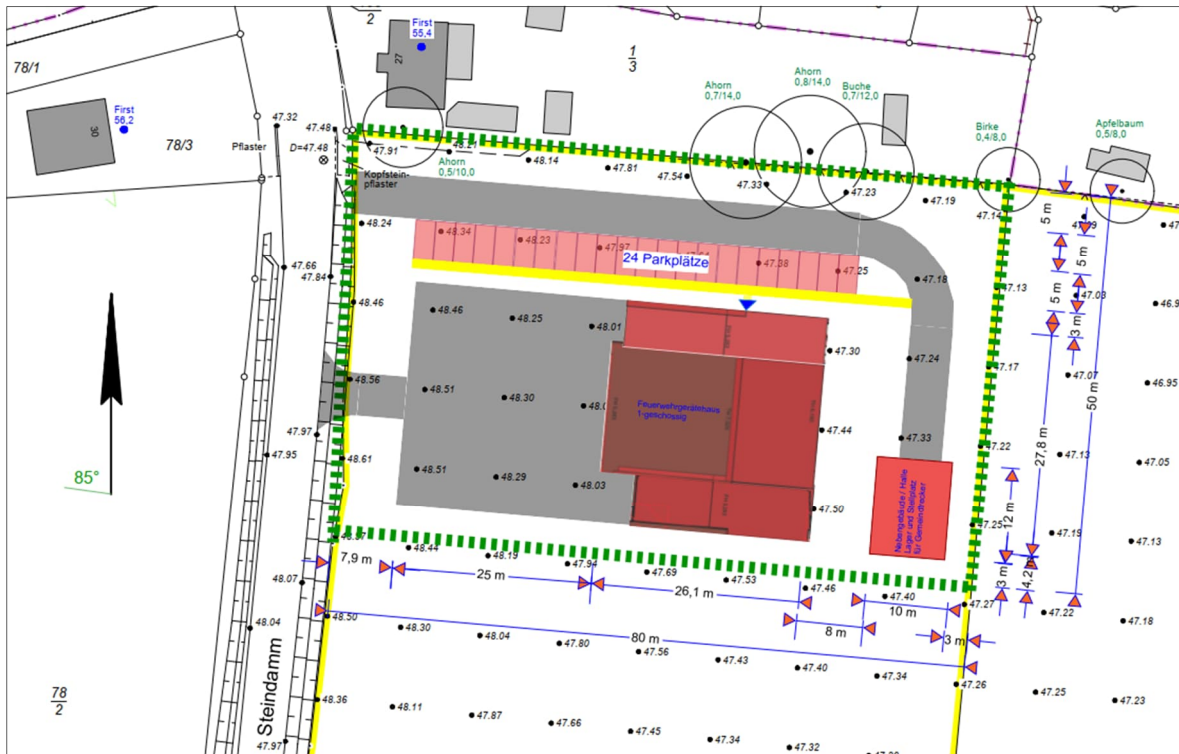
Entwurf Lageplan, Dipl. Ing. J.-Chr. Otto, Stand 26.01.24
